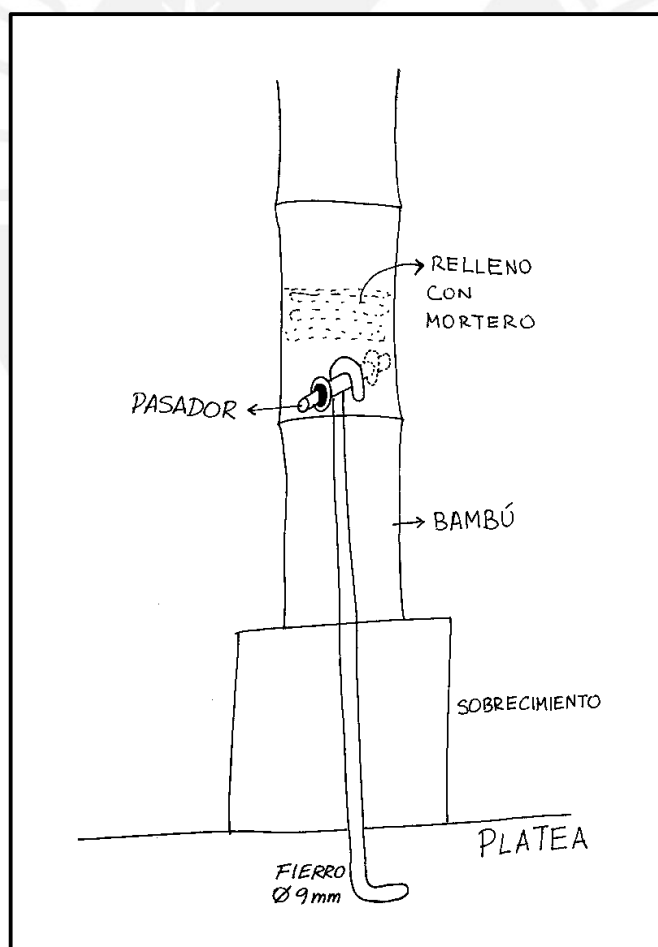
Esquema de armado y anclaje de las cañas que servirán de columnas para la vivienda.
